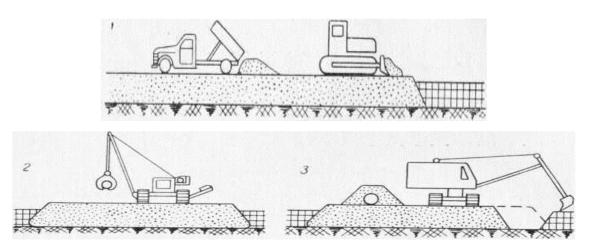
Очередность работ при прокладке трубопровода в насыпи: 1 — пионерская отсыпка насыпи; 2 — очистка, изоляция и укладка трубопровод; 3 — устройство обвалования
